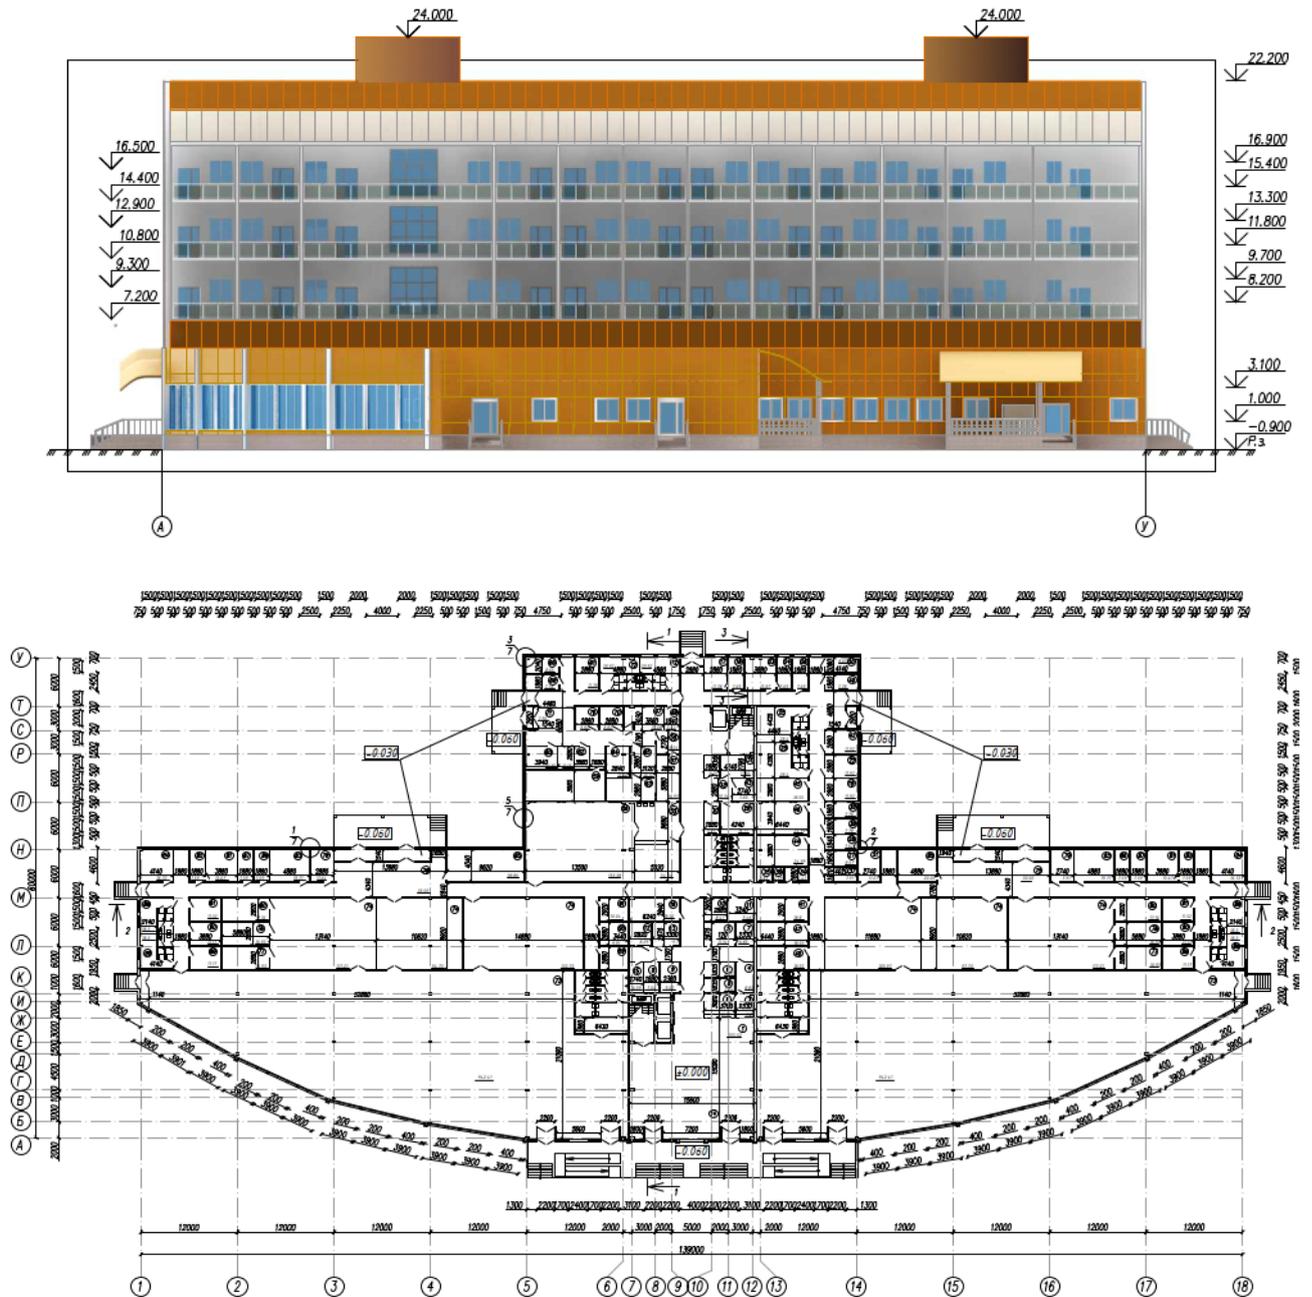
Фасад та план 1 поверху об'єкту проектування
